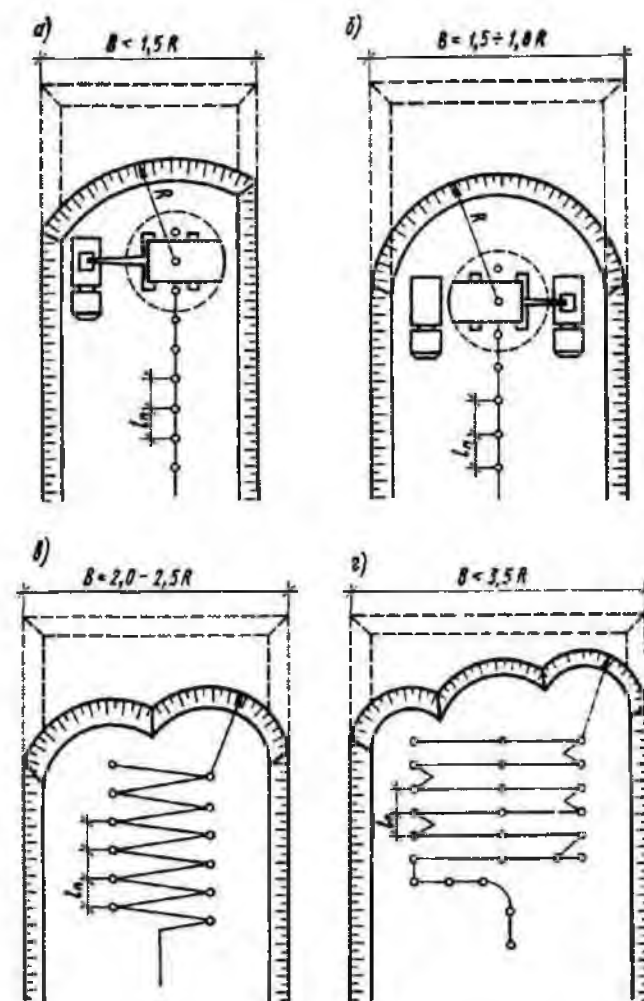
Разработка грунта экскаватором прямой лопатой:
